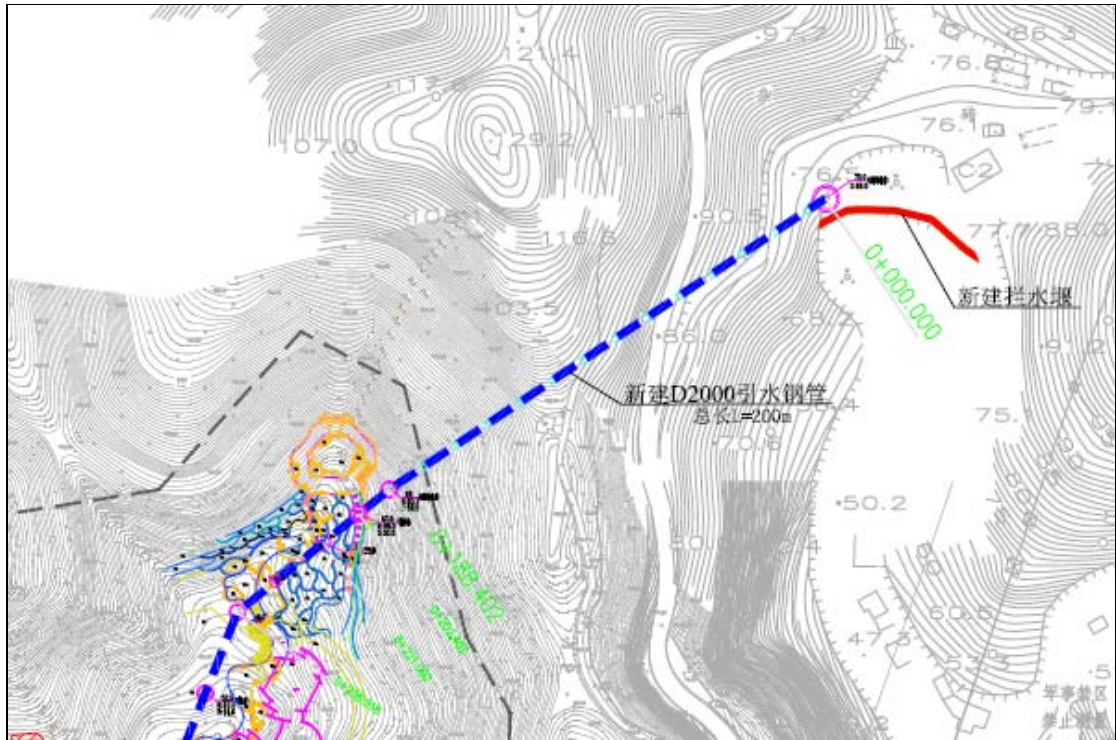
蒲谷—麓湖分洪工程平面布置图一
